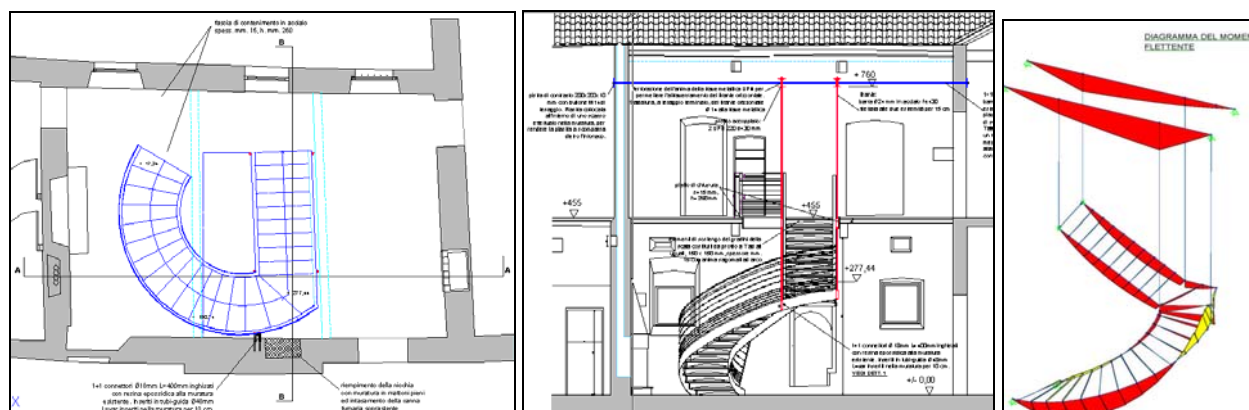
Elaborati di progetto: a) pianta b) sezione di progetto. c) modello numerico di verifica.
